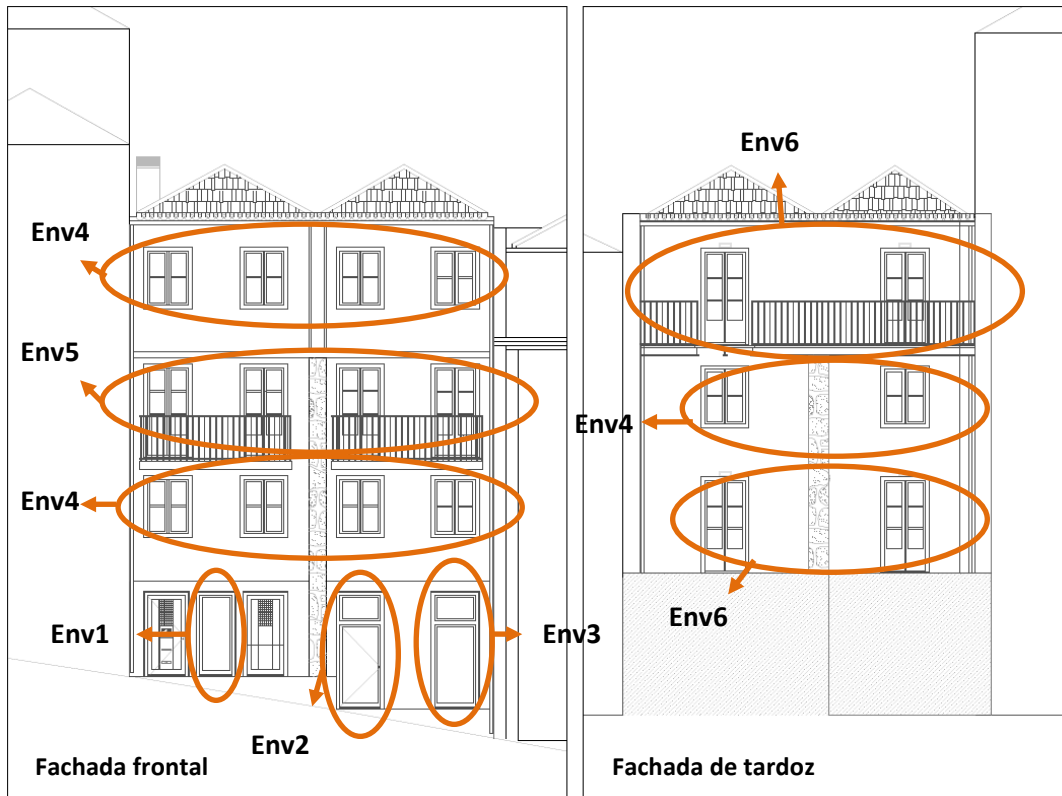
Fachadas com marcação dos envidraçados [14]
